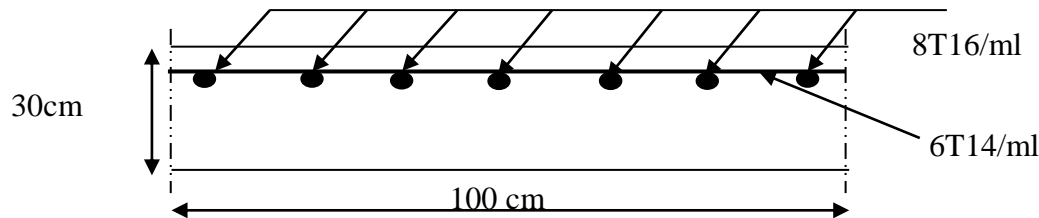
Coupe A-A ferrailage du panneau du radier sens x-x et y-y
